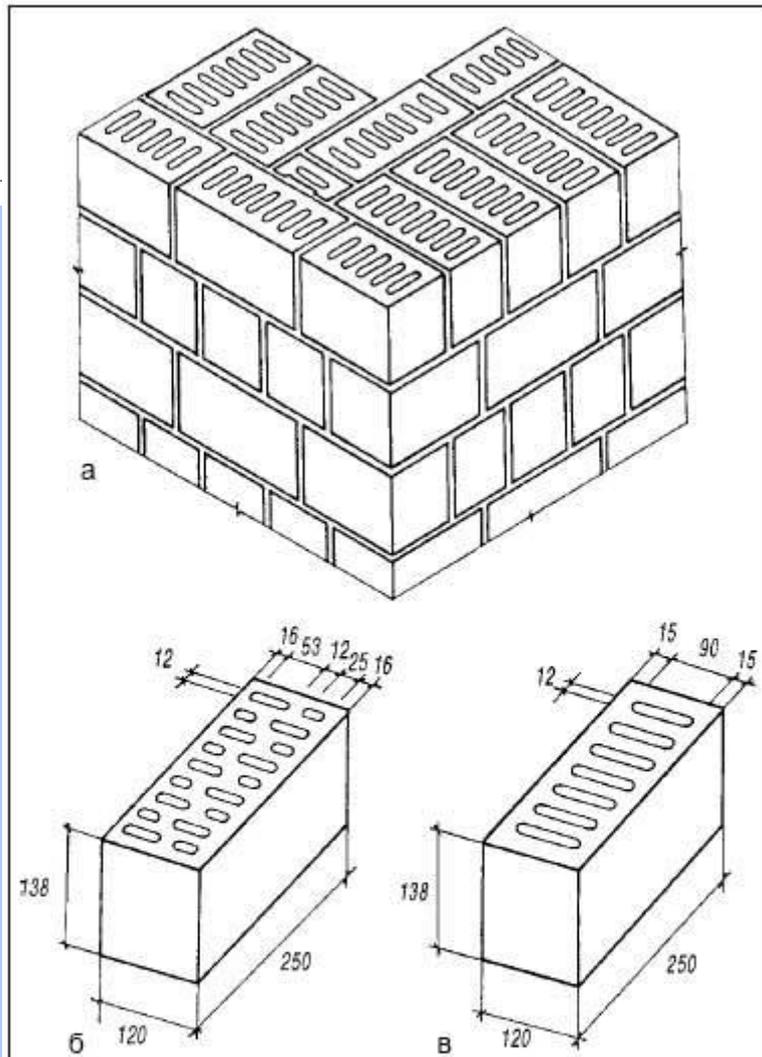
Фрагмент стены из пустотелых керамических камней:
